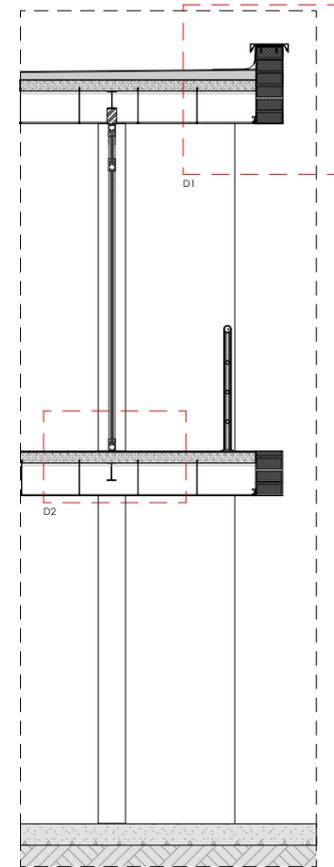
Sección constructiva 1:25 Fuente: Elaboración propia.
